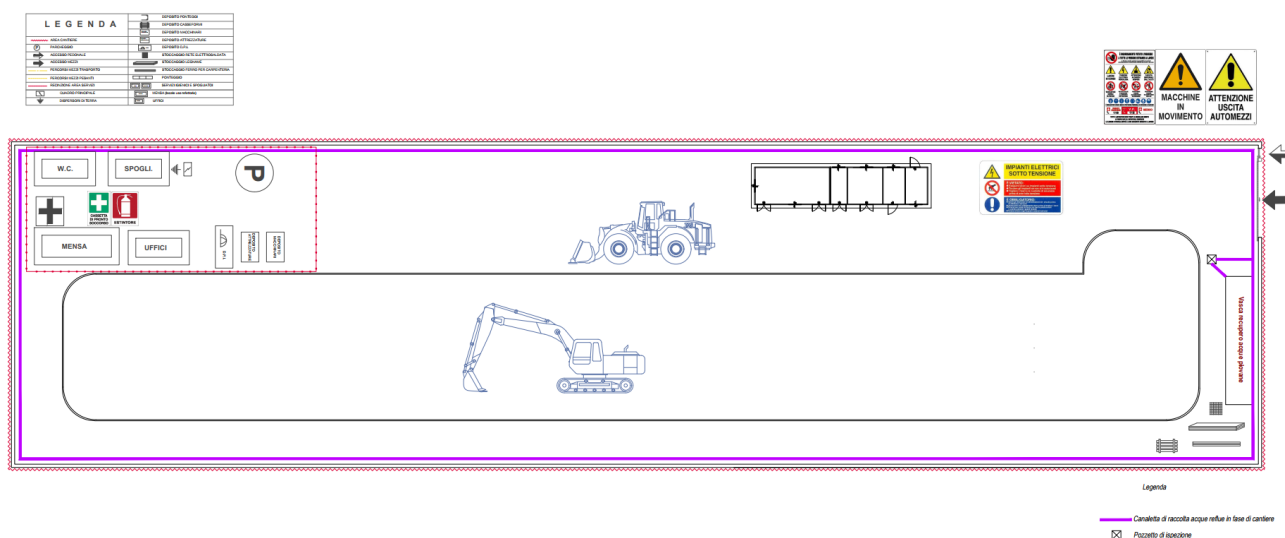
Layout di cantiere dell'impianto fotovoltaico
